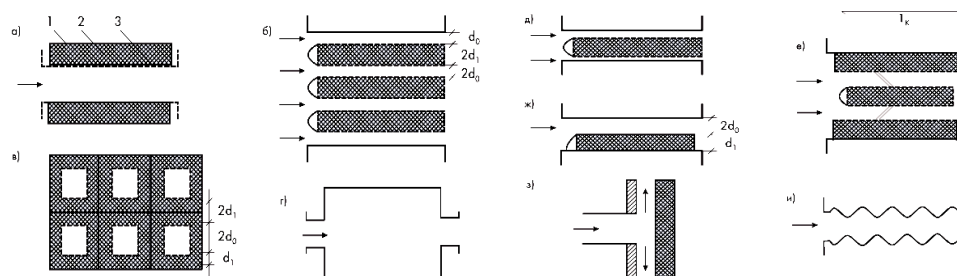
Схемы различных типов глушителей. а – трубчатый; б – пластинчатый; в – сотовый; г – камерный соосный; д – цилиндрический; е – комбинированный (цилиндрический с трубчатым); ж – каналный; з – экранный; и – гибкий воздуховод. 1 – корпус; 2 – звукопоглощающий материал; 3 – перфорированное покрытие.
